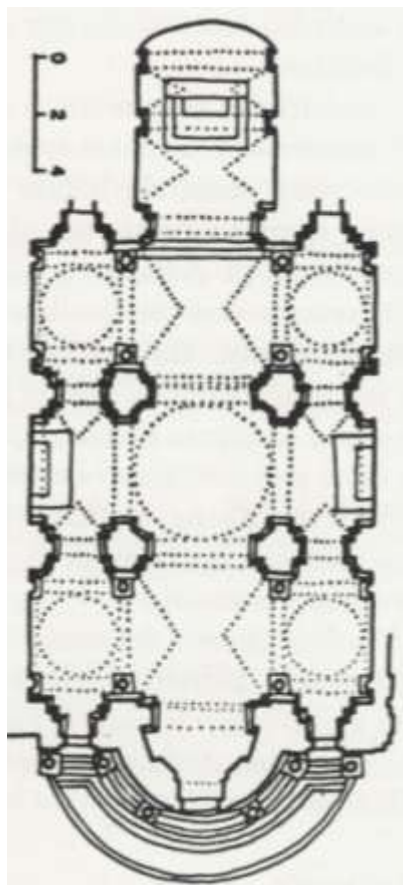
Chiesa di San Domenico, Noto. Pianta
